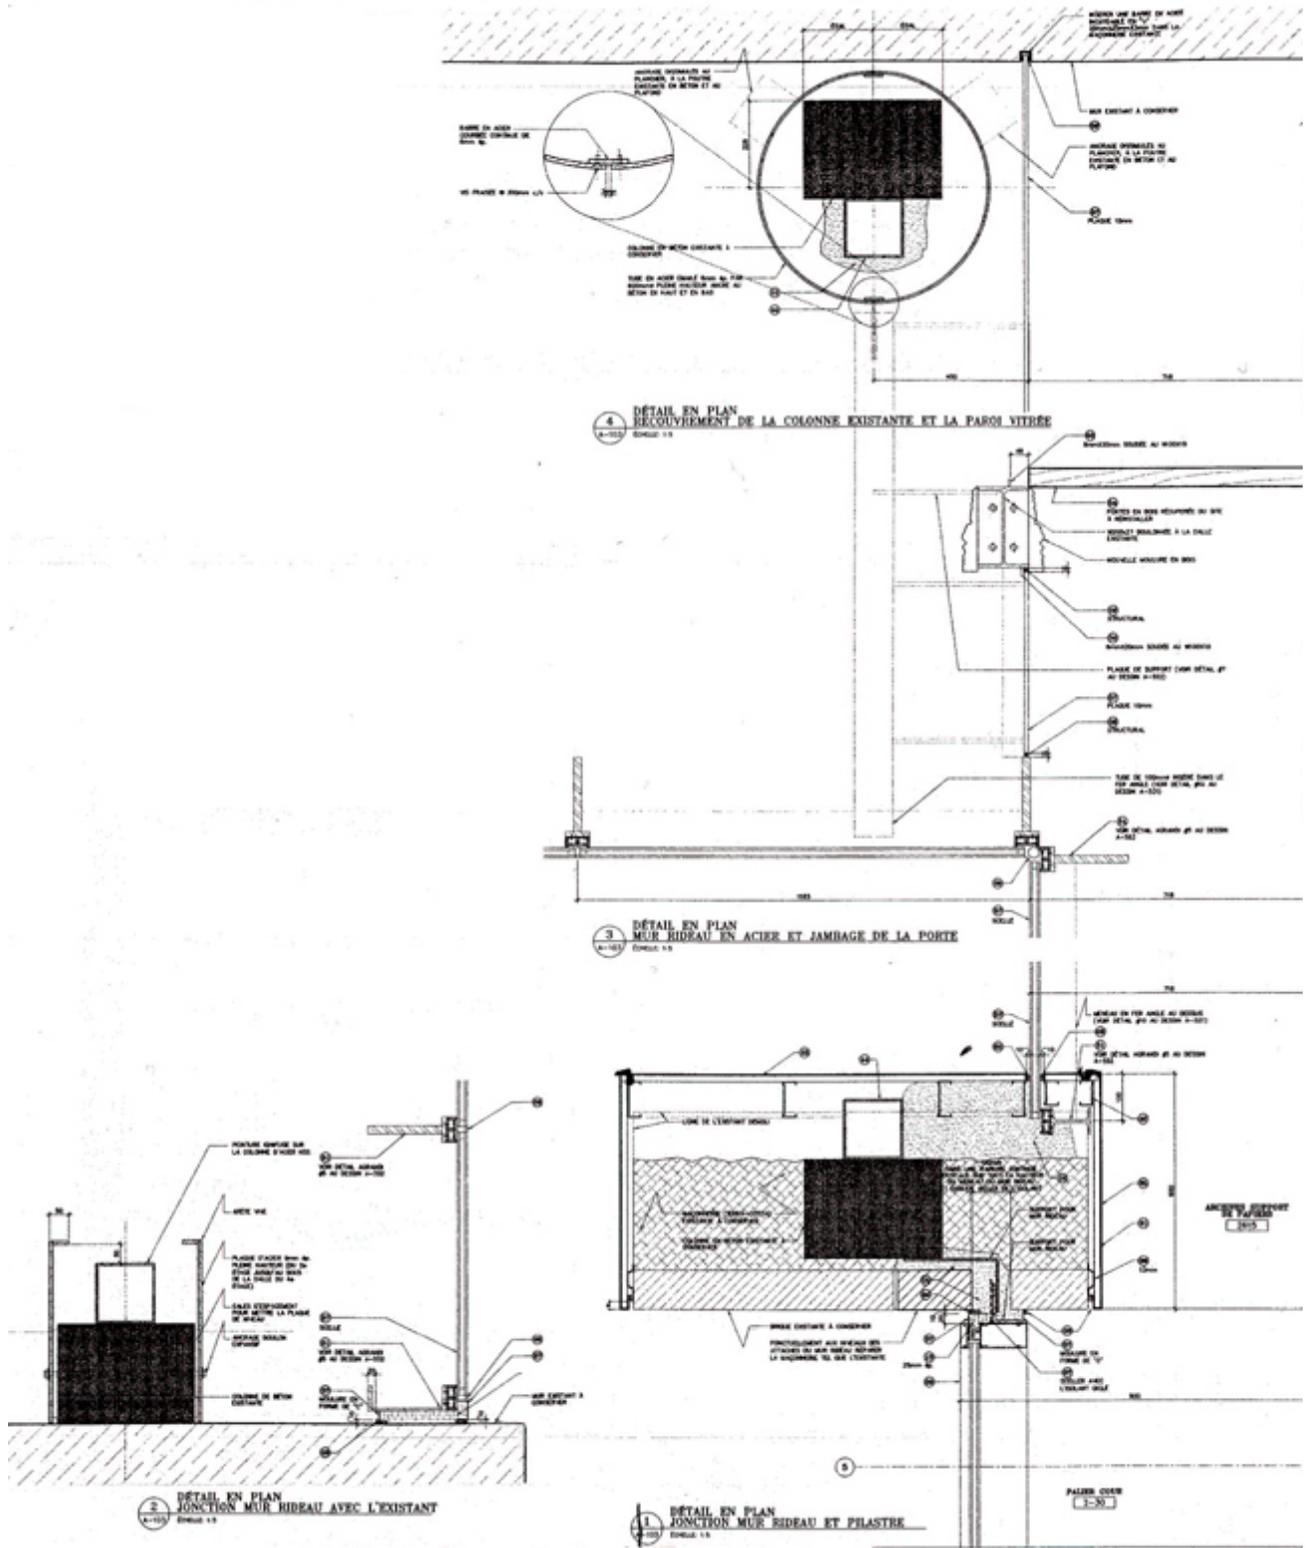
Détail en coupe horizontale du système structural du mur-rideau (Source : Dan S. Hanganu Architectes).
